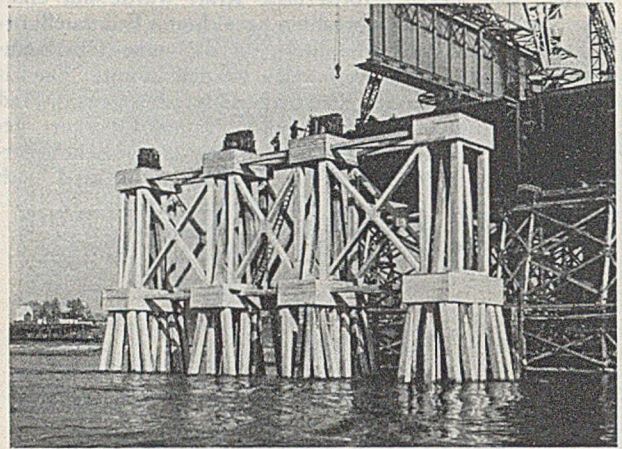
Stahlbetonjoch bei Punkt 6'.
